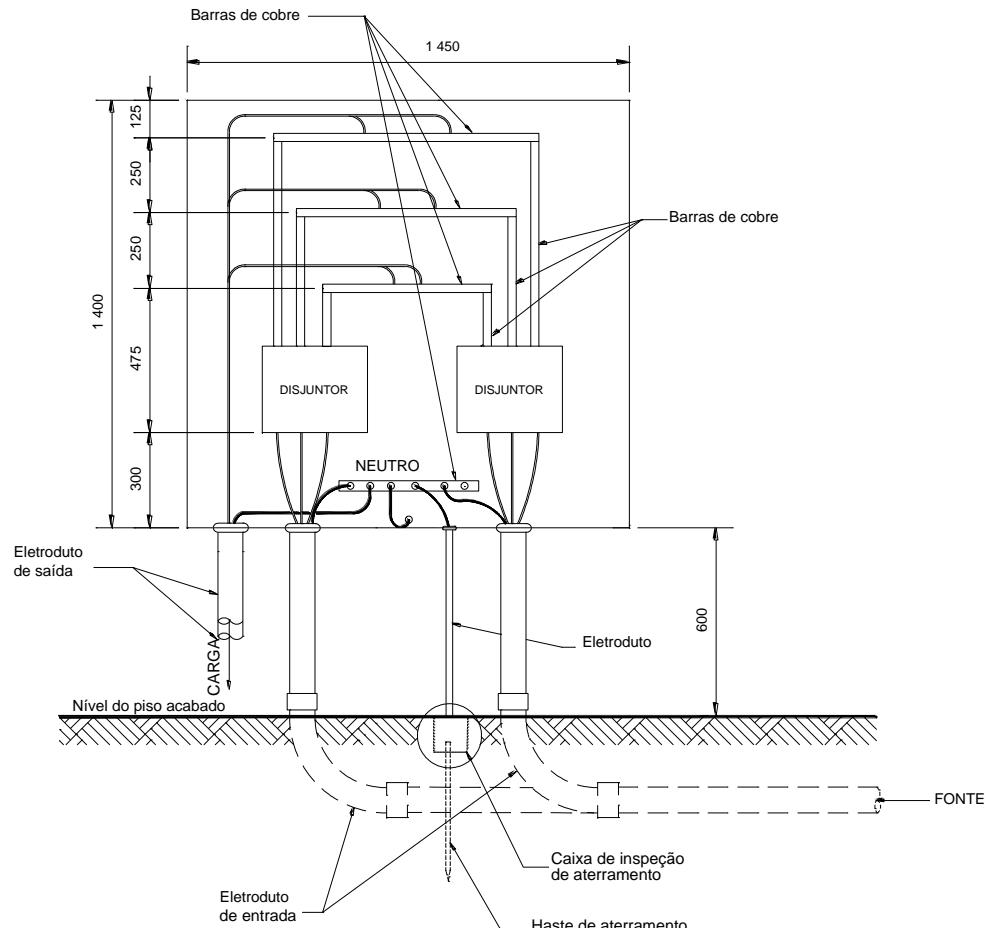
Instalação da proteção da caixa seccionadora tipo T
